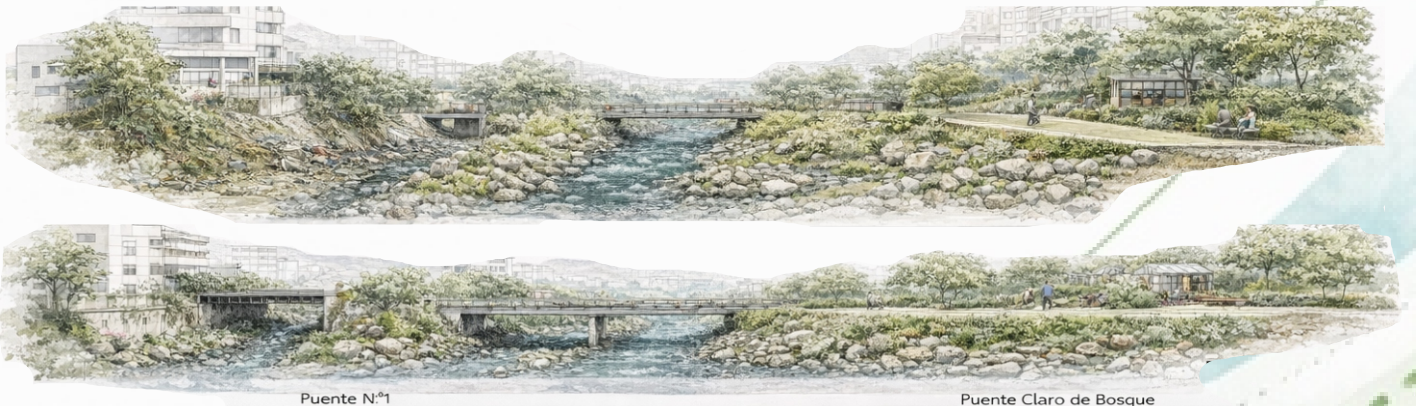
Secciones longitudinales, desarrollo proyectual del tramo piloto.
